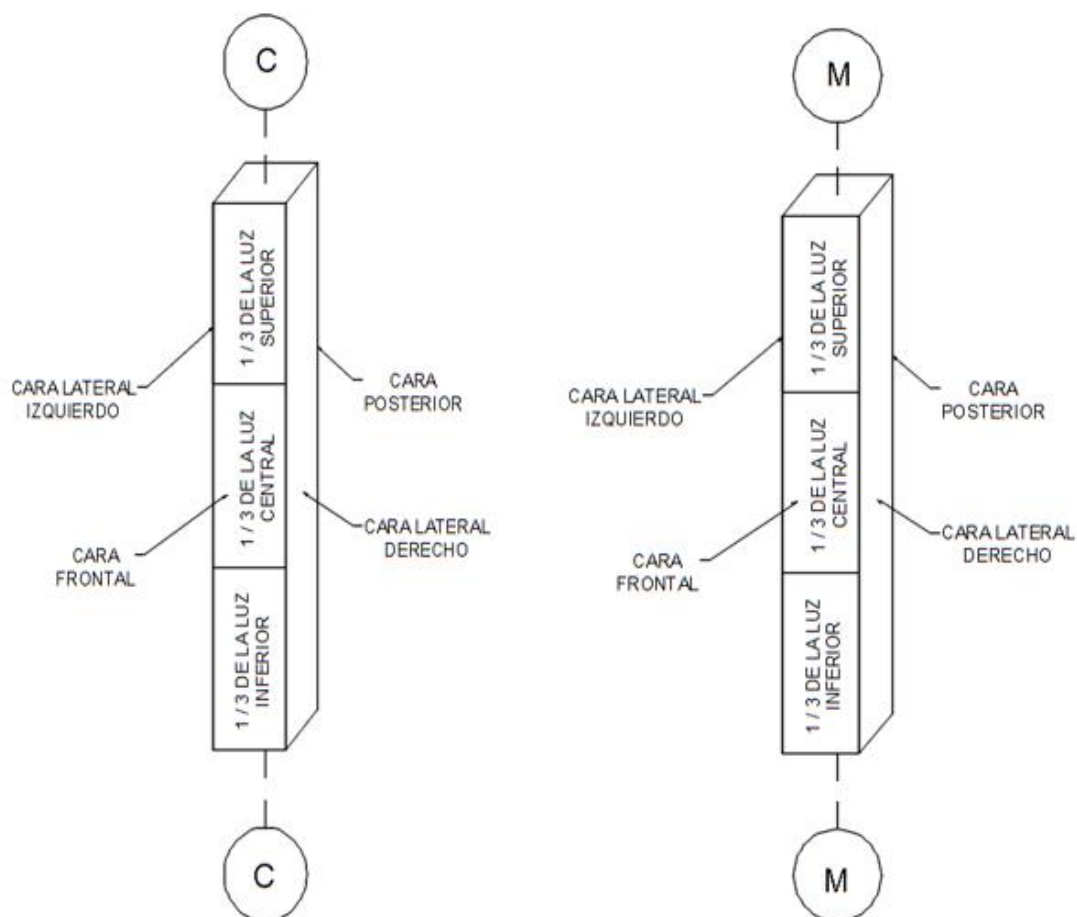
Ubicación de columnas (C) y machones (M). Fuente: los autores
